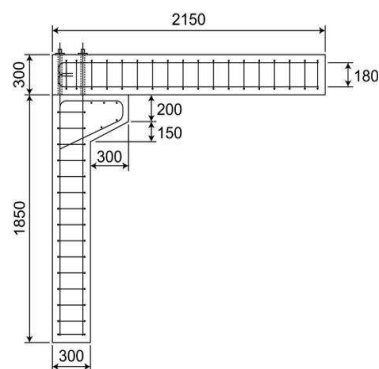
試験体形状寸法 (PJ-H) (単位:mm)
